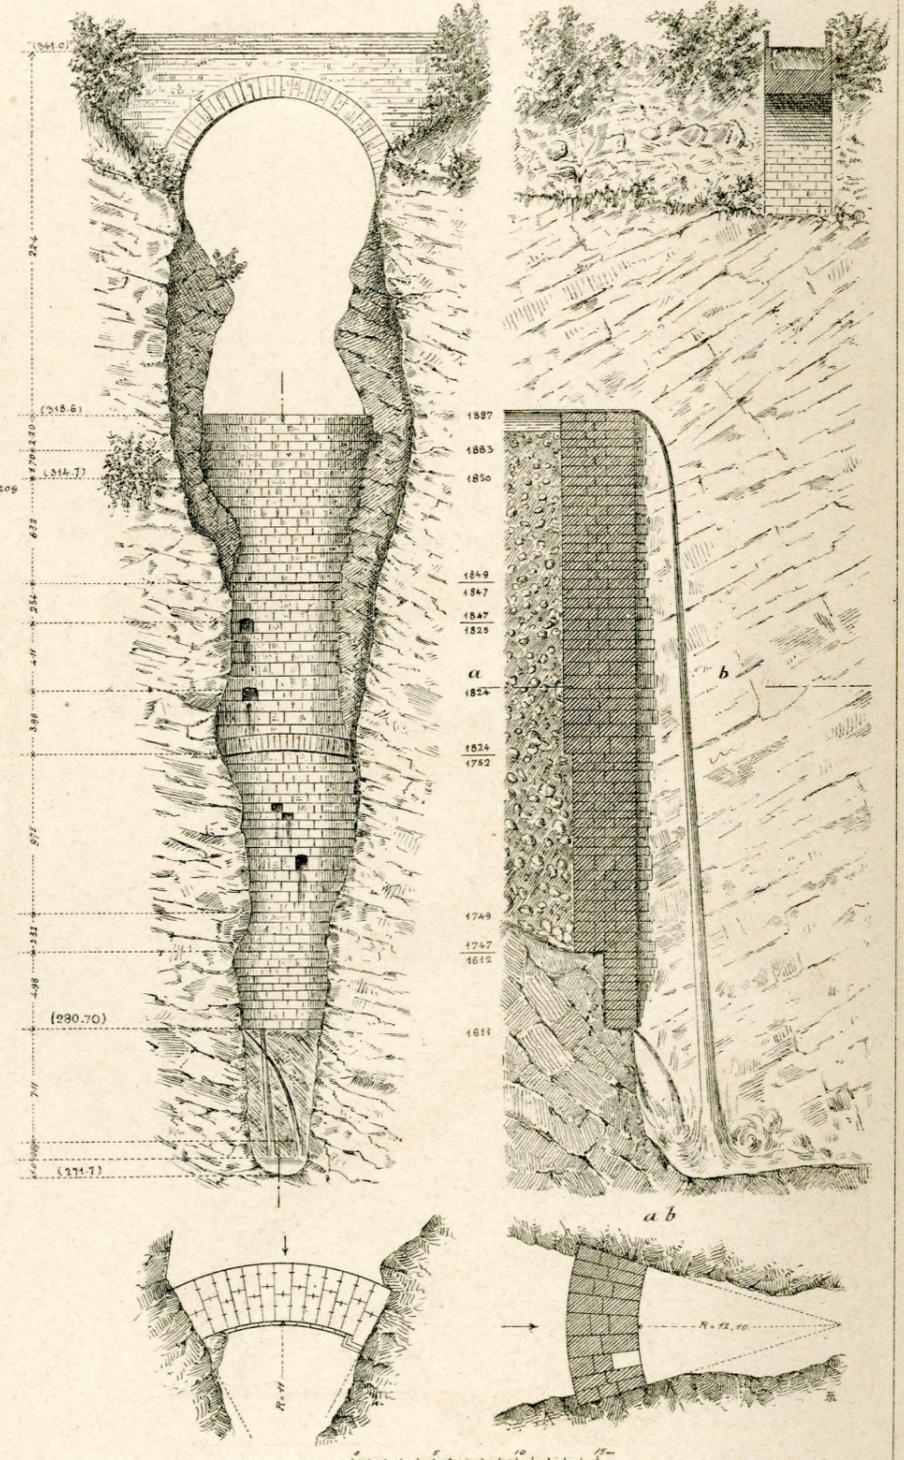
e 6. - Serra di Cantanghel: Planimetria e sezione trasversale.
